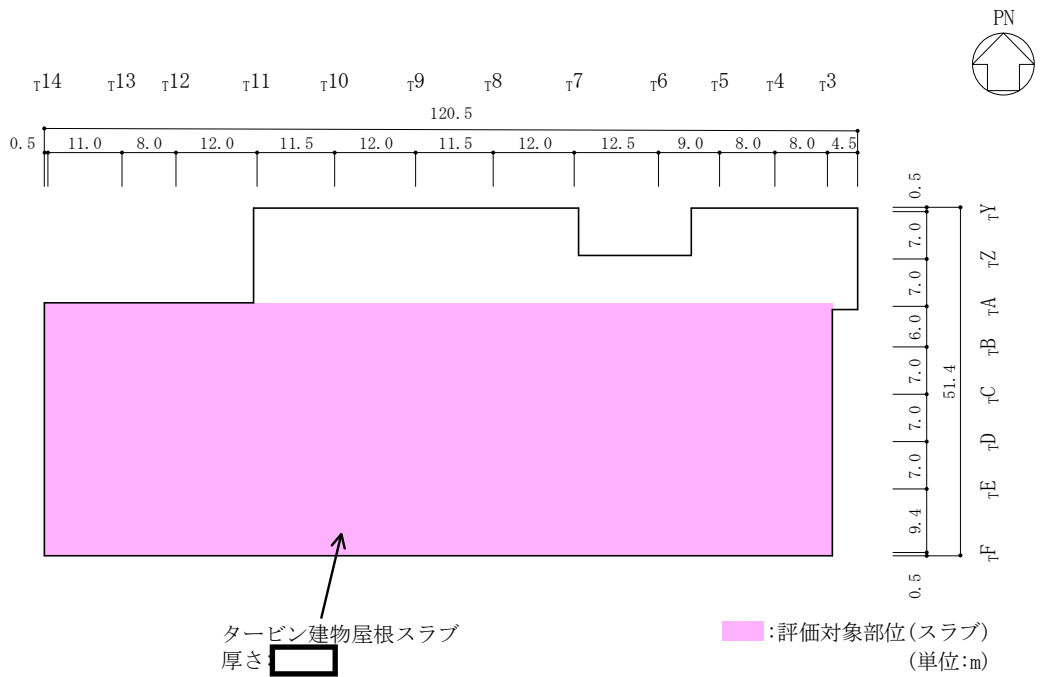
(2) タービン建物の概略平面図 (EL 41.6m)
